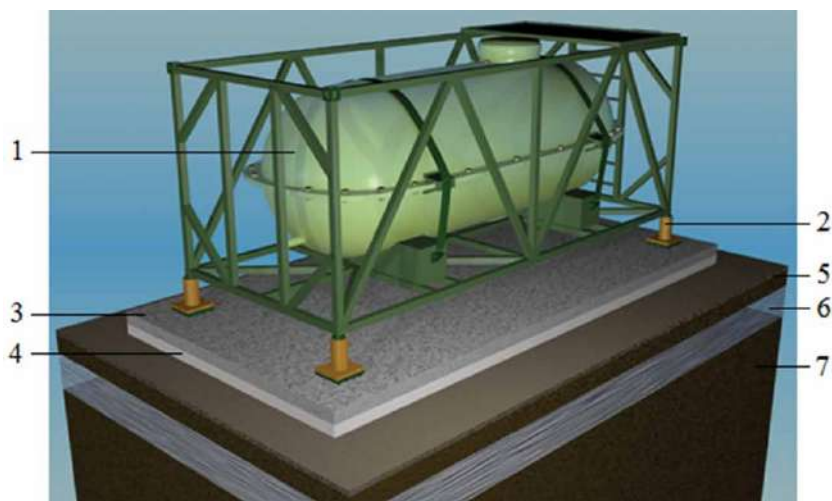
Фрагмент постановки бетонной площадки на сваях в грунт
